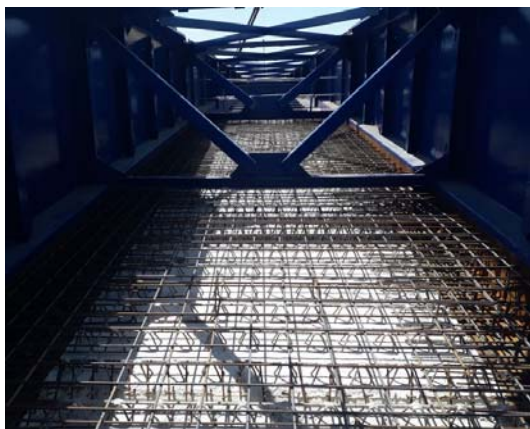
Detalle de celosías en zona de hormigón de fondo durante la construcción.
